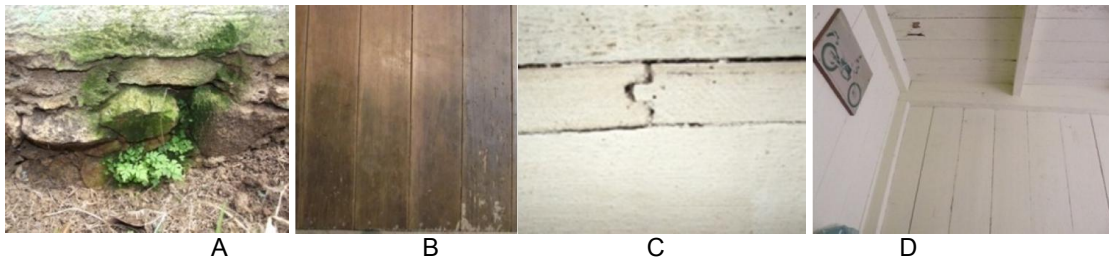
ALICERCE DE PEDRAS (A), PISO DE TÁBUAS (B), ENCAIXE DO PISO E PAREDES (C), PAREDES INTERNAS COM AS VIGAS DA ESTRUTURA DO TELHADO (D)
